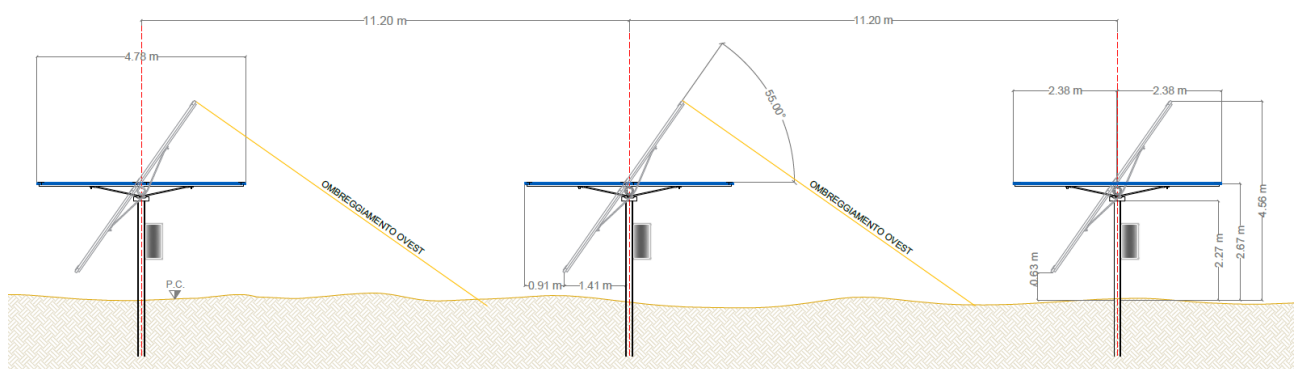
Vista frontale con rotazione di 55° ovest e distanza longitudinale tra le strutture
